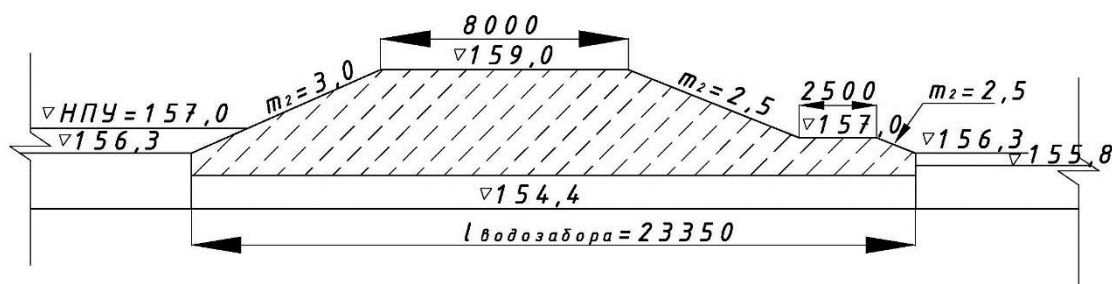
Схема к гидравлическому расчету водозабора
